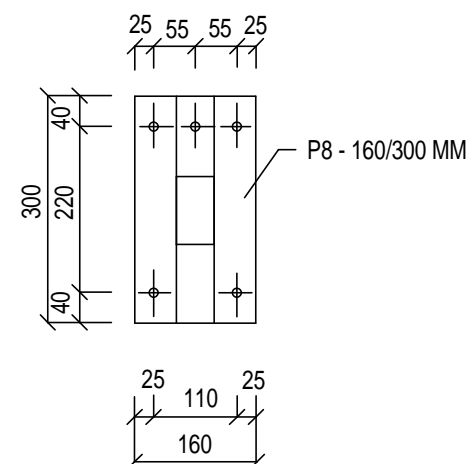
DETAIL A - KOTVENÍ (SVISLÝ ŘEZ)
